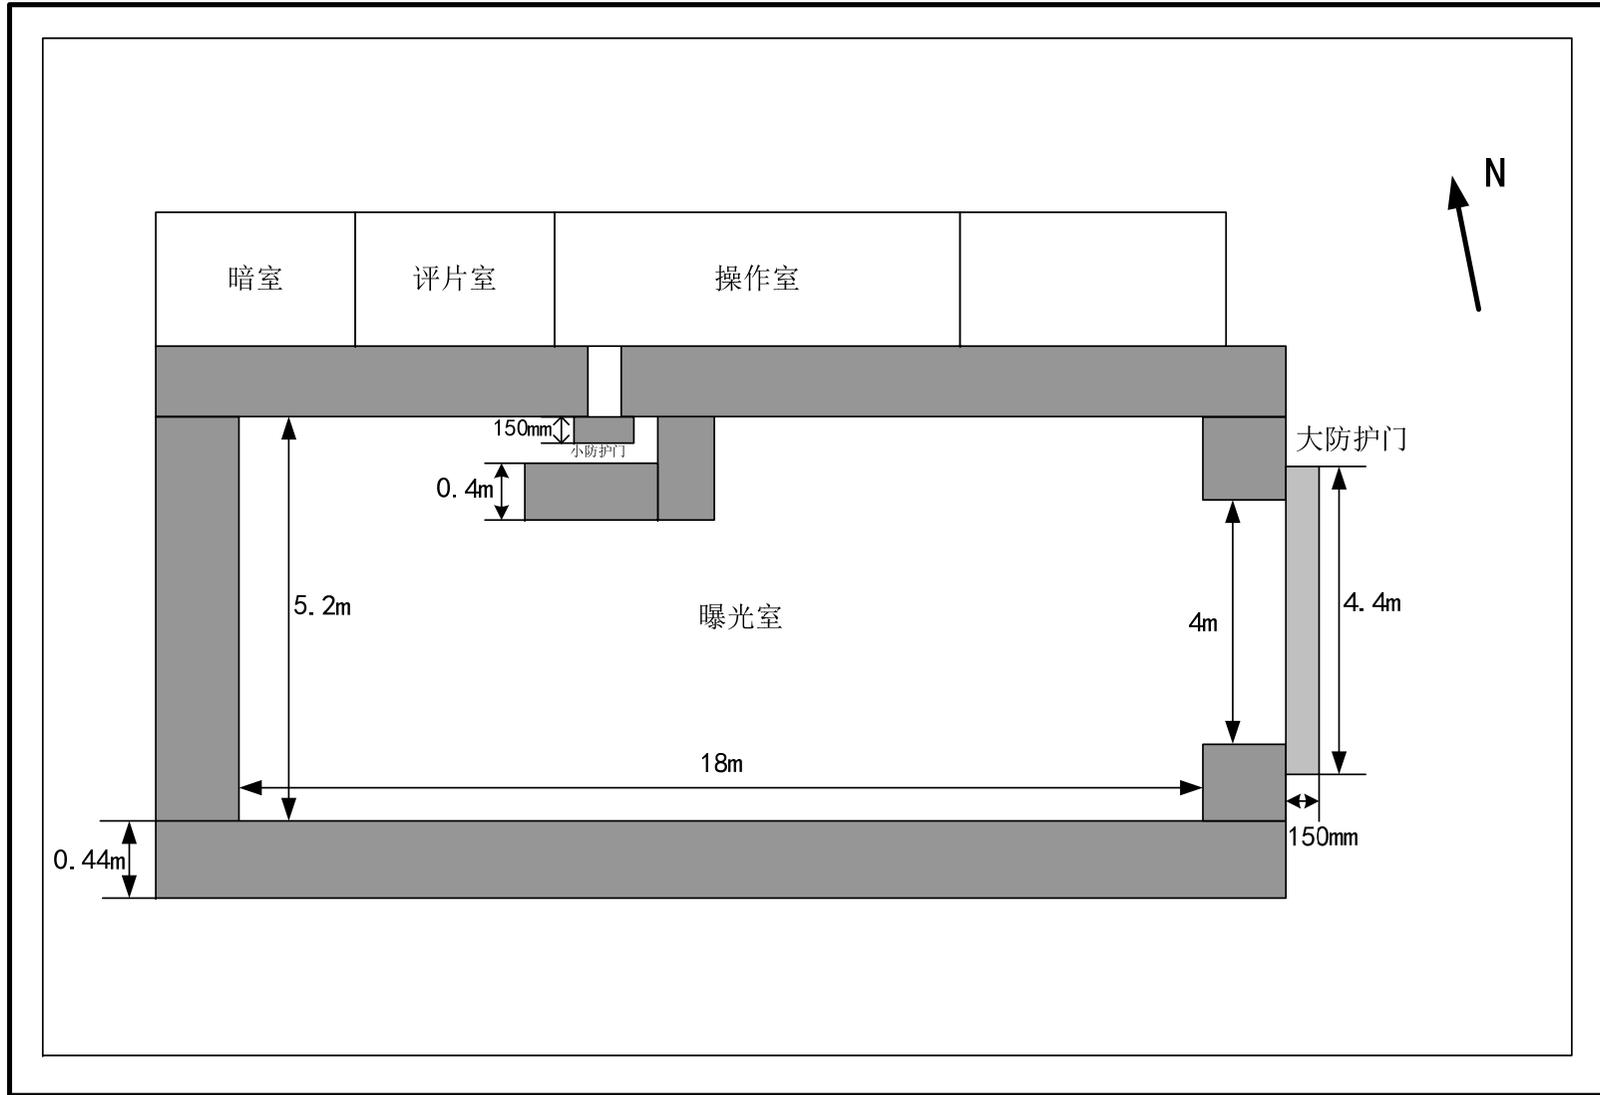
本项目探伤室总平面布置图 比例尺:1:110
